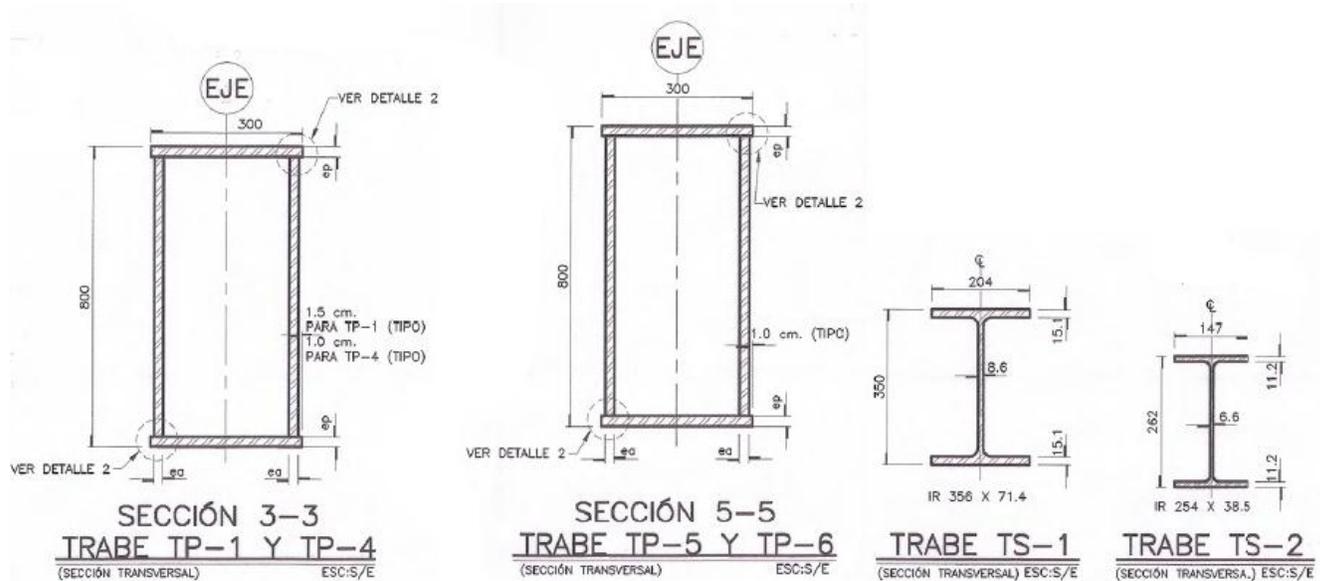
Sección traveses tipo cajón longitudinales y transversales principales TP-1, TP-4, TP-5 y TP-5, traveses secundarias transversales perfil IR TS-1 y Traveses TS-2
